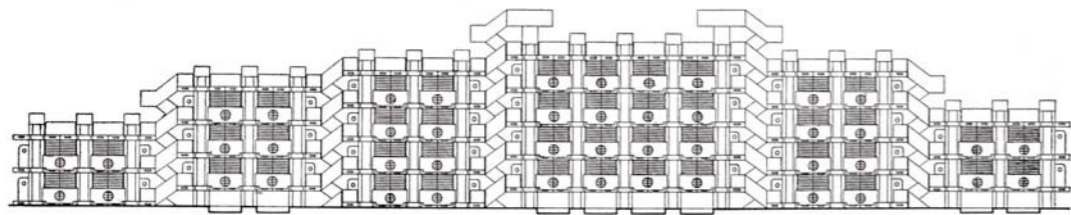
KUROKAWA, Noriaki (Kisho) – *Concrete component housing*, Japan, 1962. Alçado de uma unidade de habitação.
